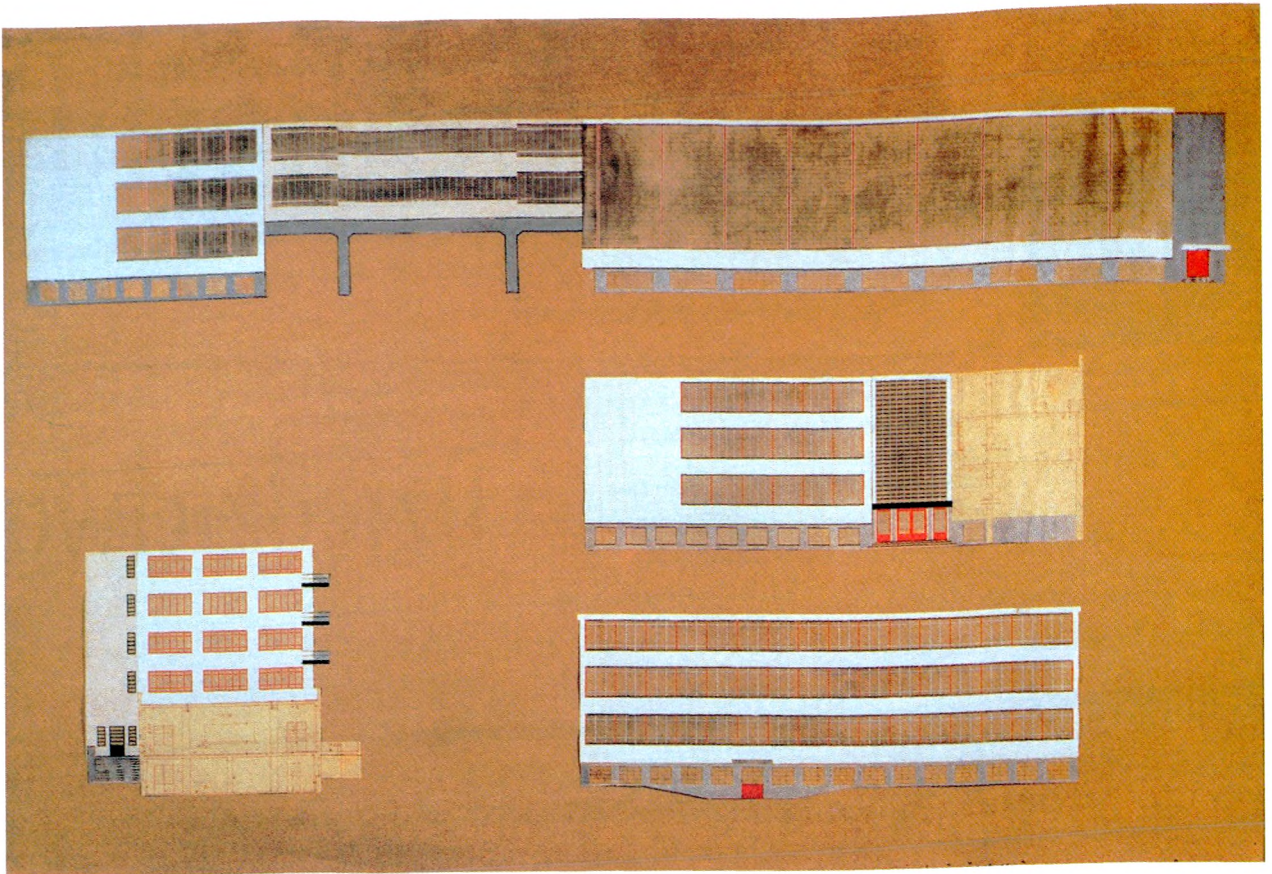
Hinnerk Scheper, Farbplan des Bauhausgebäudes, Fassaden, 1926
